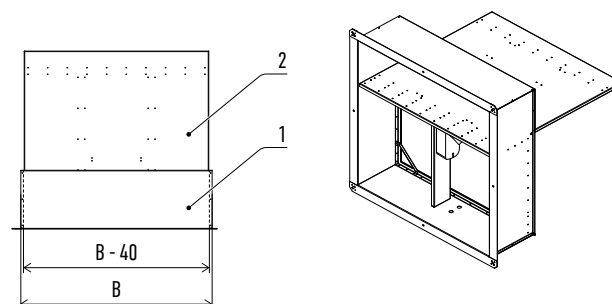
Стеновой клапан прямоугольного сечения
